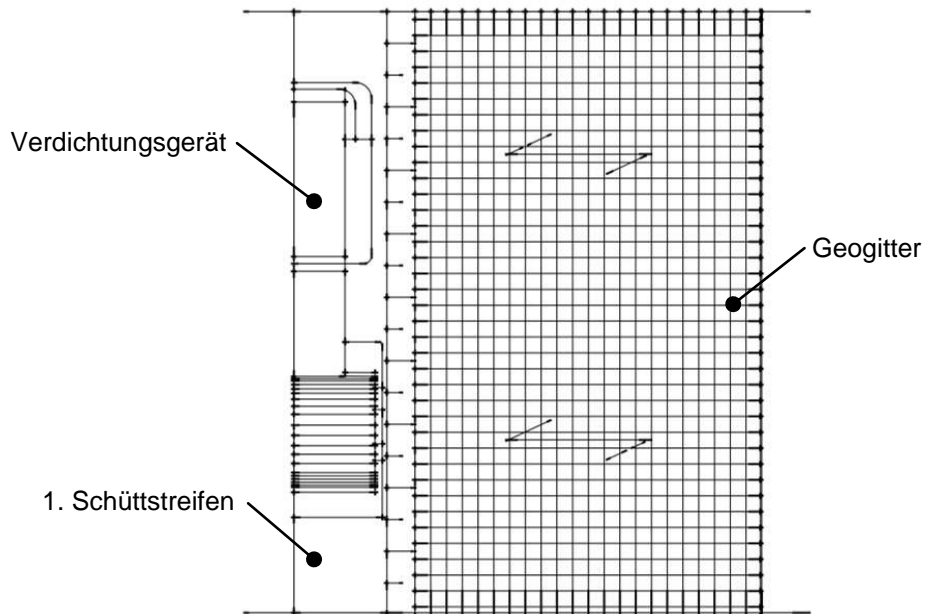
Verdichten des ersten Schüttstreifens – Grundriss
